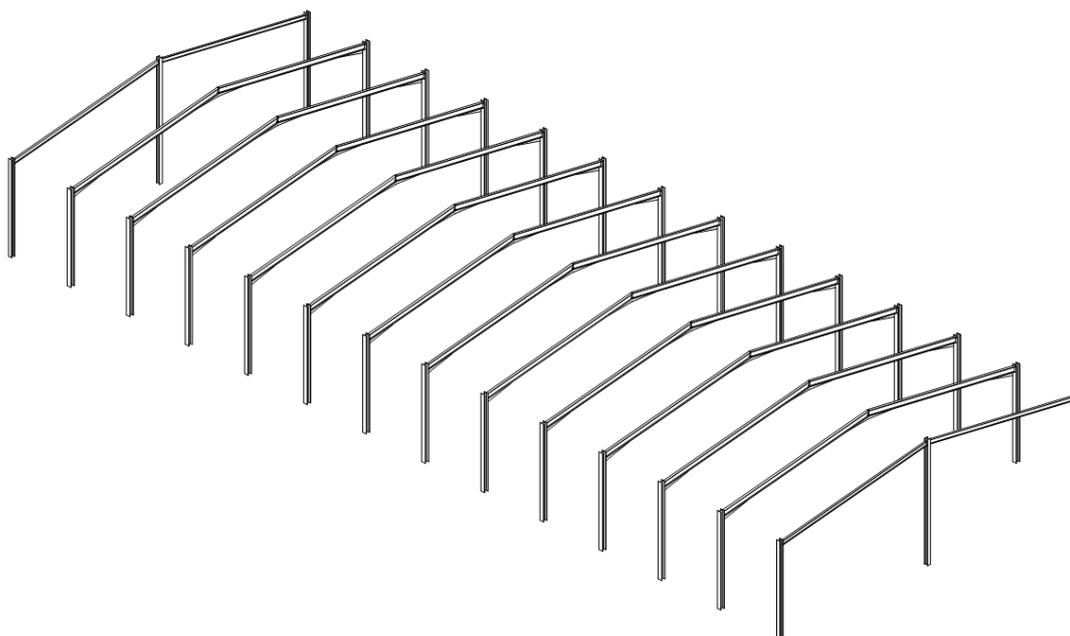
Esquema tridimensional de la estructura. Elaboración propia
